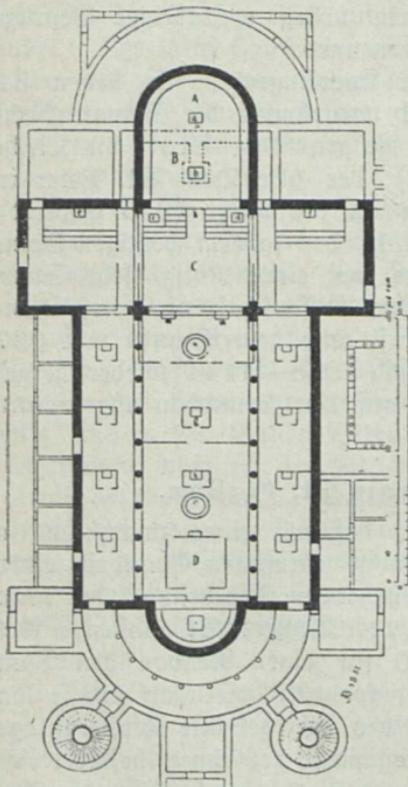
Grundriß der Klosterkirche von St. Gallen. (Nach Dehio und v. Bezold.)
